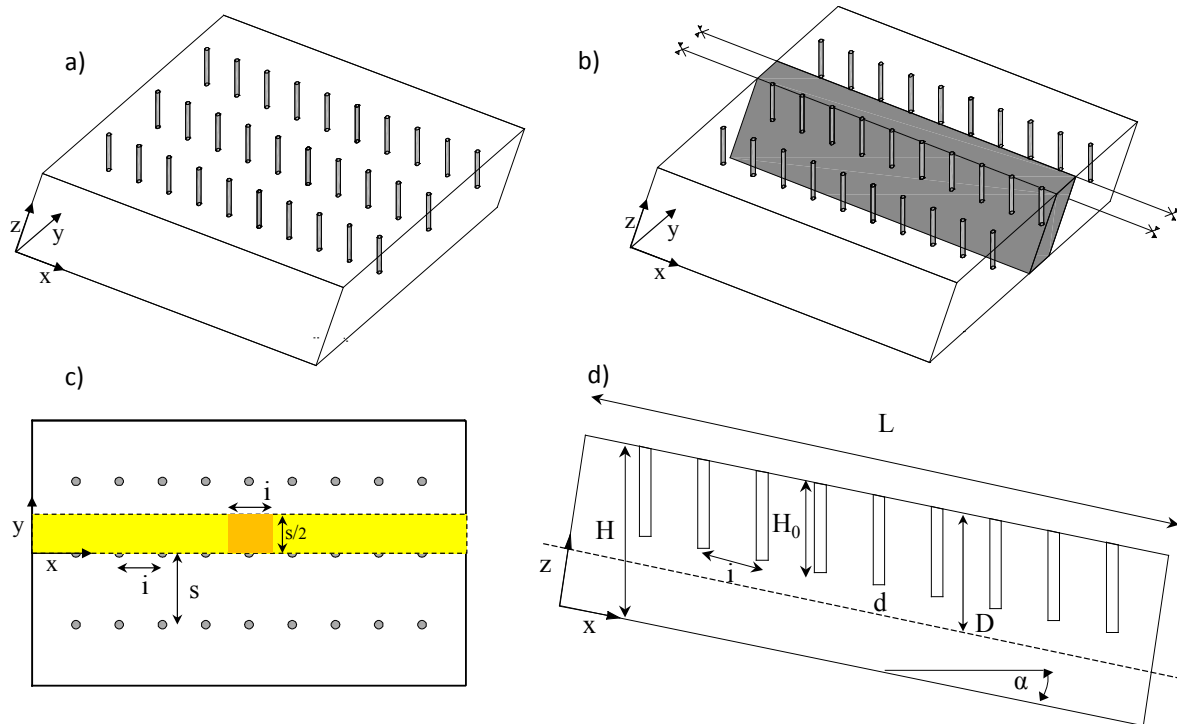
Sistema reticolare di pozzi: a) Geometria 3D. b) Dominio di riferimento. c) Pianta. d) Sezione longitudinale.
